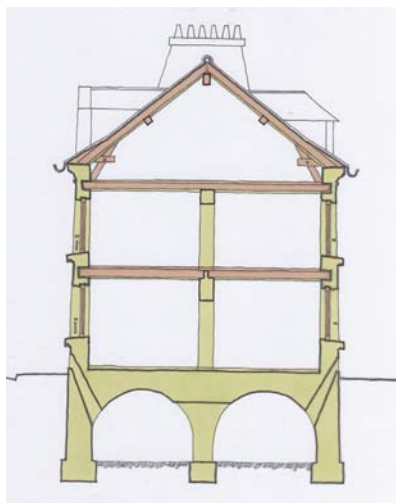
cas d'un plancher complet poutres encastrées, enfermées dans un caisson en plâtre (bâtiment 3) :
